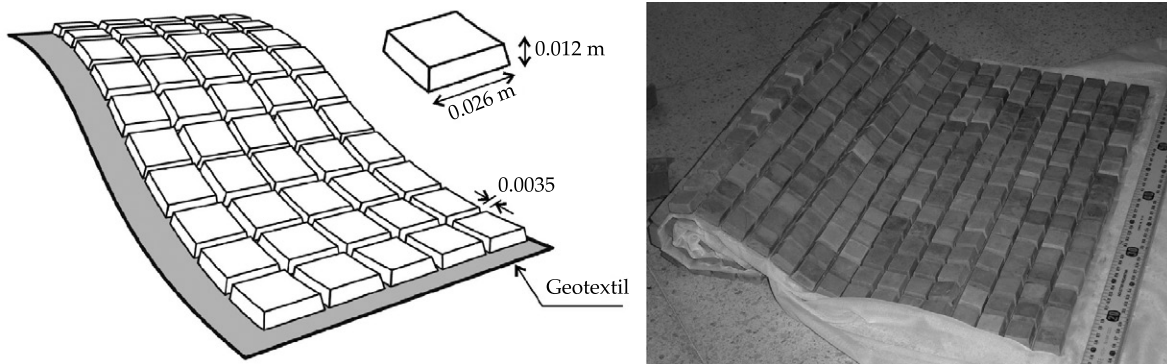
Mantas de bloques de concreto adheridos a geotextil usadas en los experimentos.
